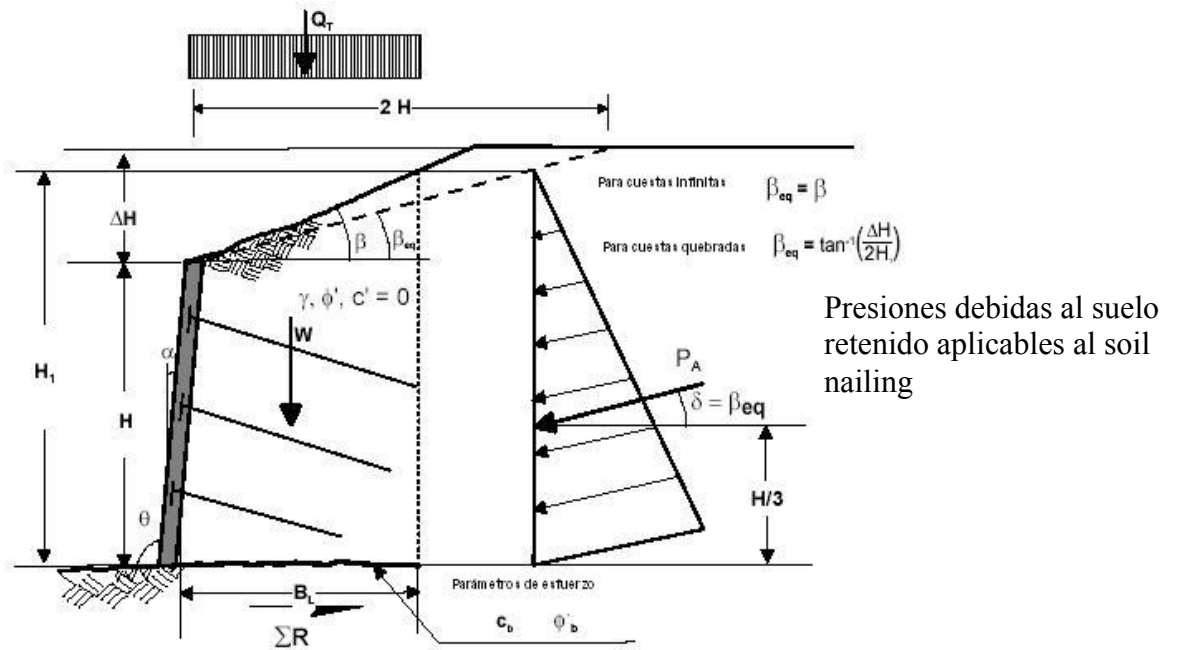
23 Estabilidad por deslizamiento de un muro de soil nailing (detalle típico).
